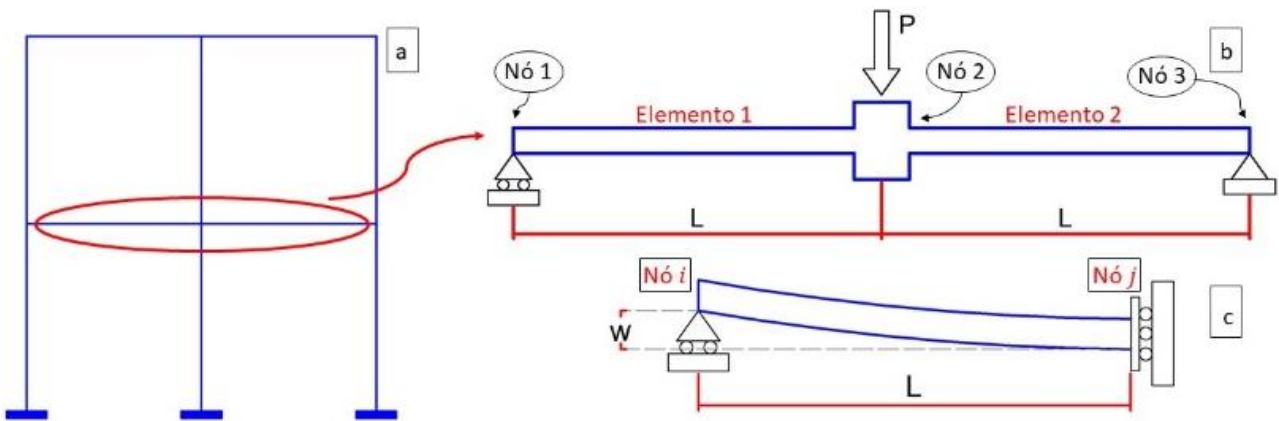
Elemento estrutural, sendo: a) pórtico; b) junta pilar viga; c) simetria do elemento com deslocamento w .
